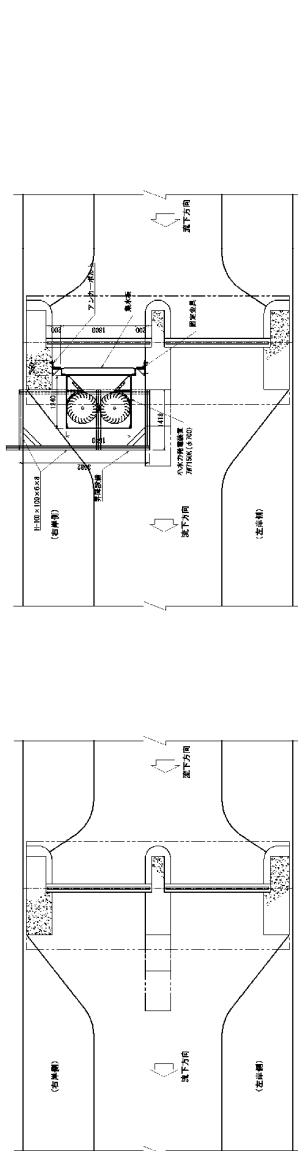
平面配置図 (左：現状、右：水車発電機設置後)
